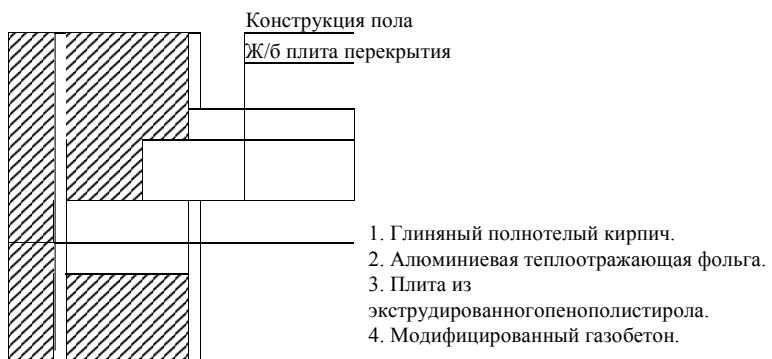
Конструктивная схема наружной стены жилого дома.
